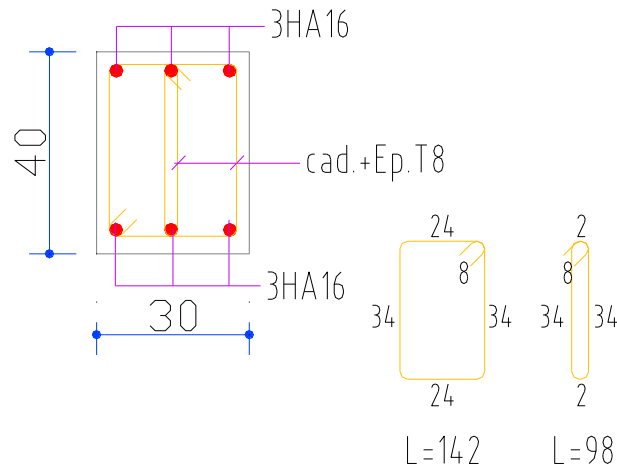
Ferrailage des poutres principales au niveau de travée de 1^{er} à 3^{ème} et de 12^{ème} et 13^{ème} étage.
